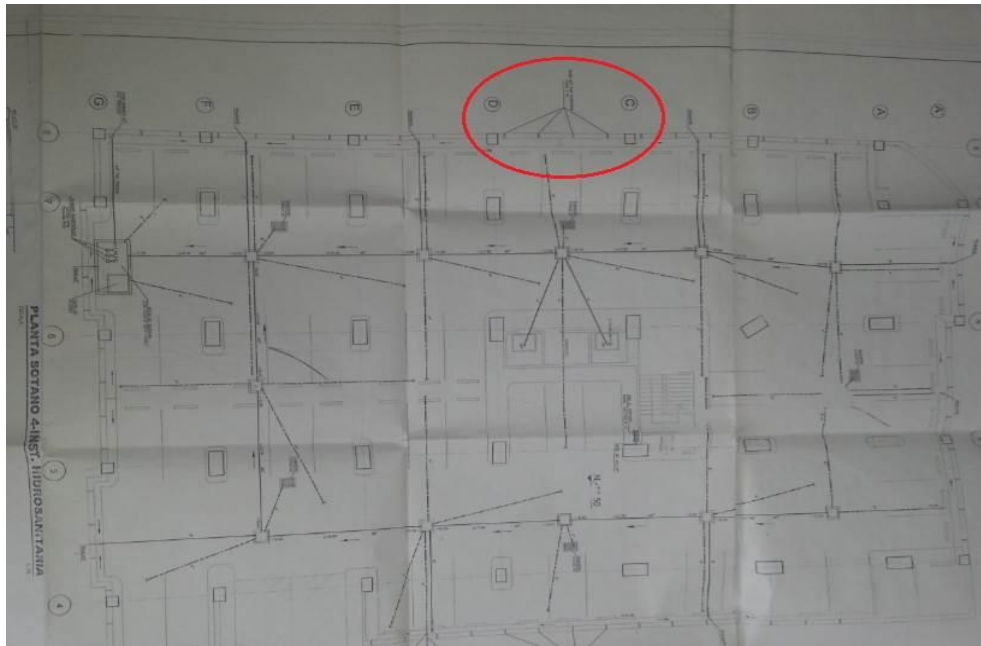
Planta de distribución de desagües (Fuente Planos de Obra)
